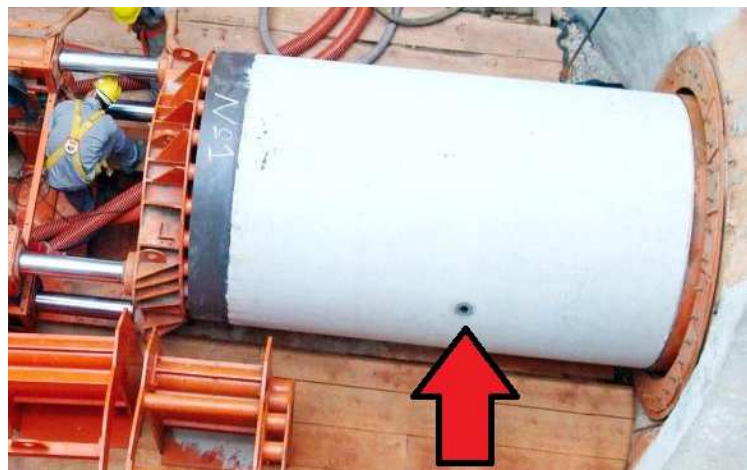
Cravação de tubo de concreto com furo para injeção de lubrificante
